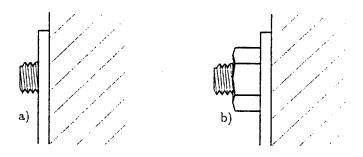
Installation et serrage d'un goujon à autoexpansion : a) avant serrage, b) après serrage.
